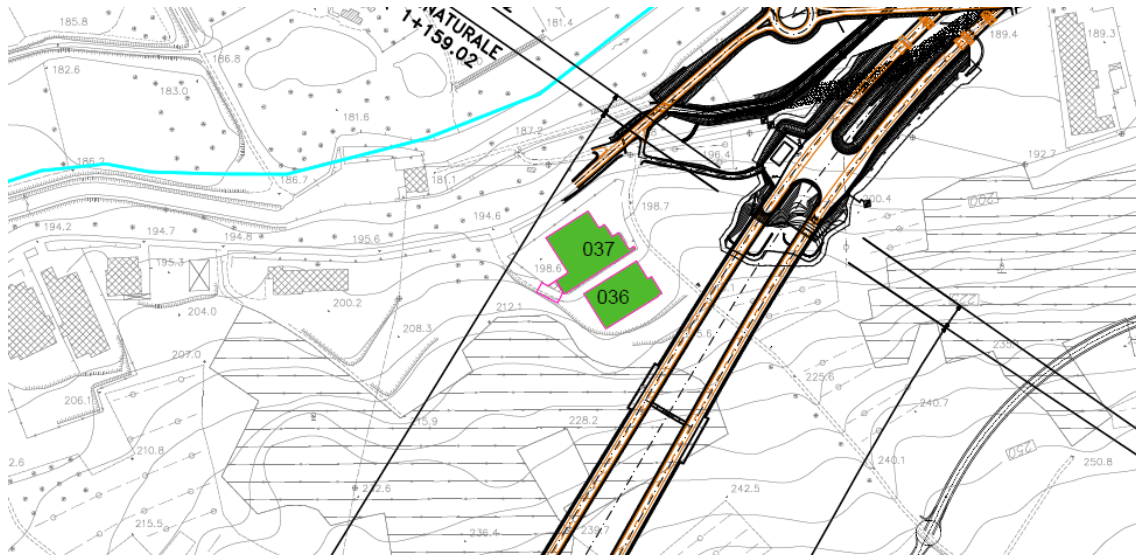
Planimetria edifici interferenti (Imbocco Alba)
